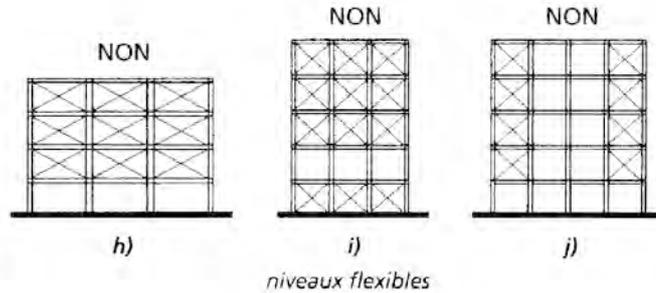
Dispositions pouvant être à l'origine de l'effondrement de bâtiments en raison de la présence de niveaux souples.
